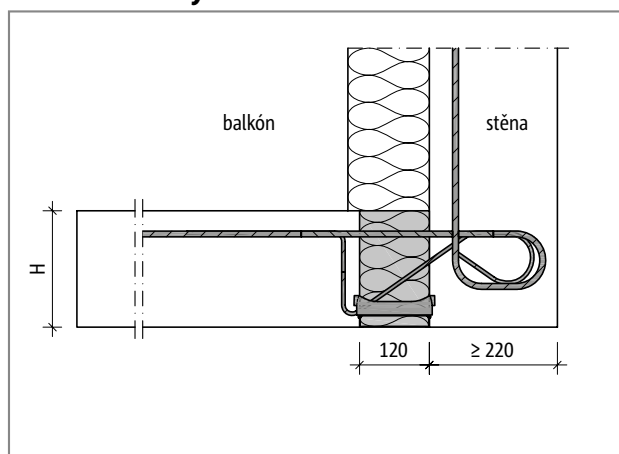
Schöck Isokorb® typ KXT-BH: Balkón zvýšený oproti stropní desce, vnější zateplení
